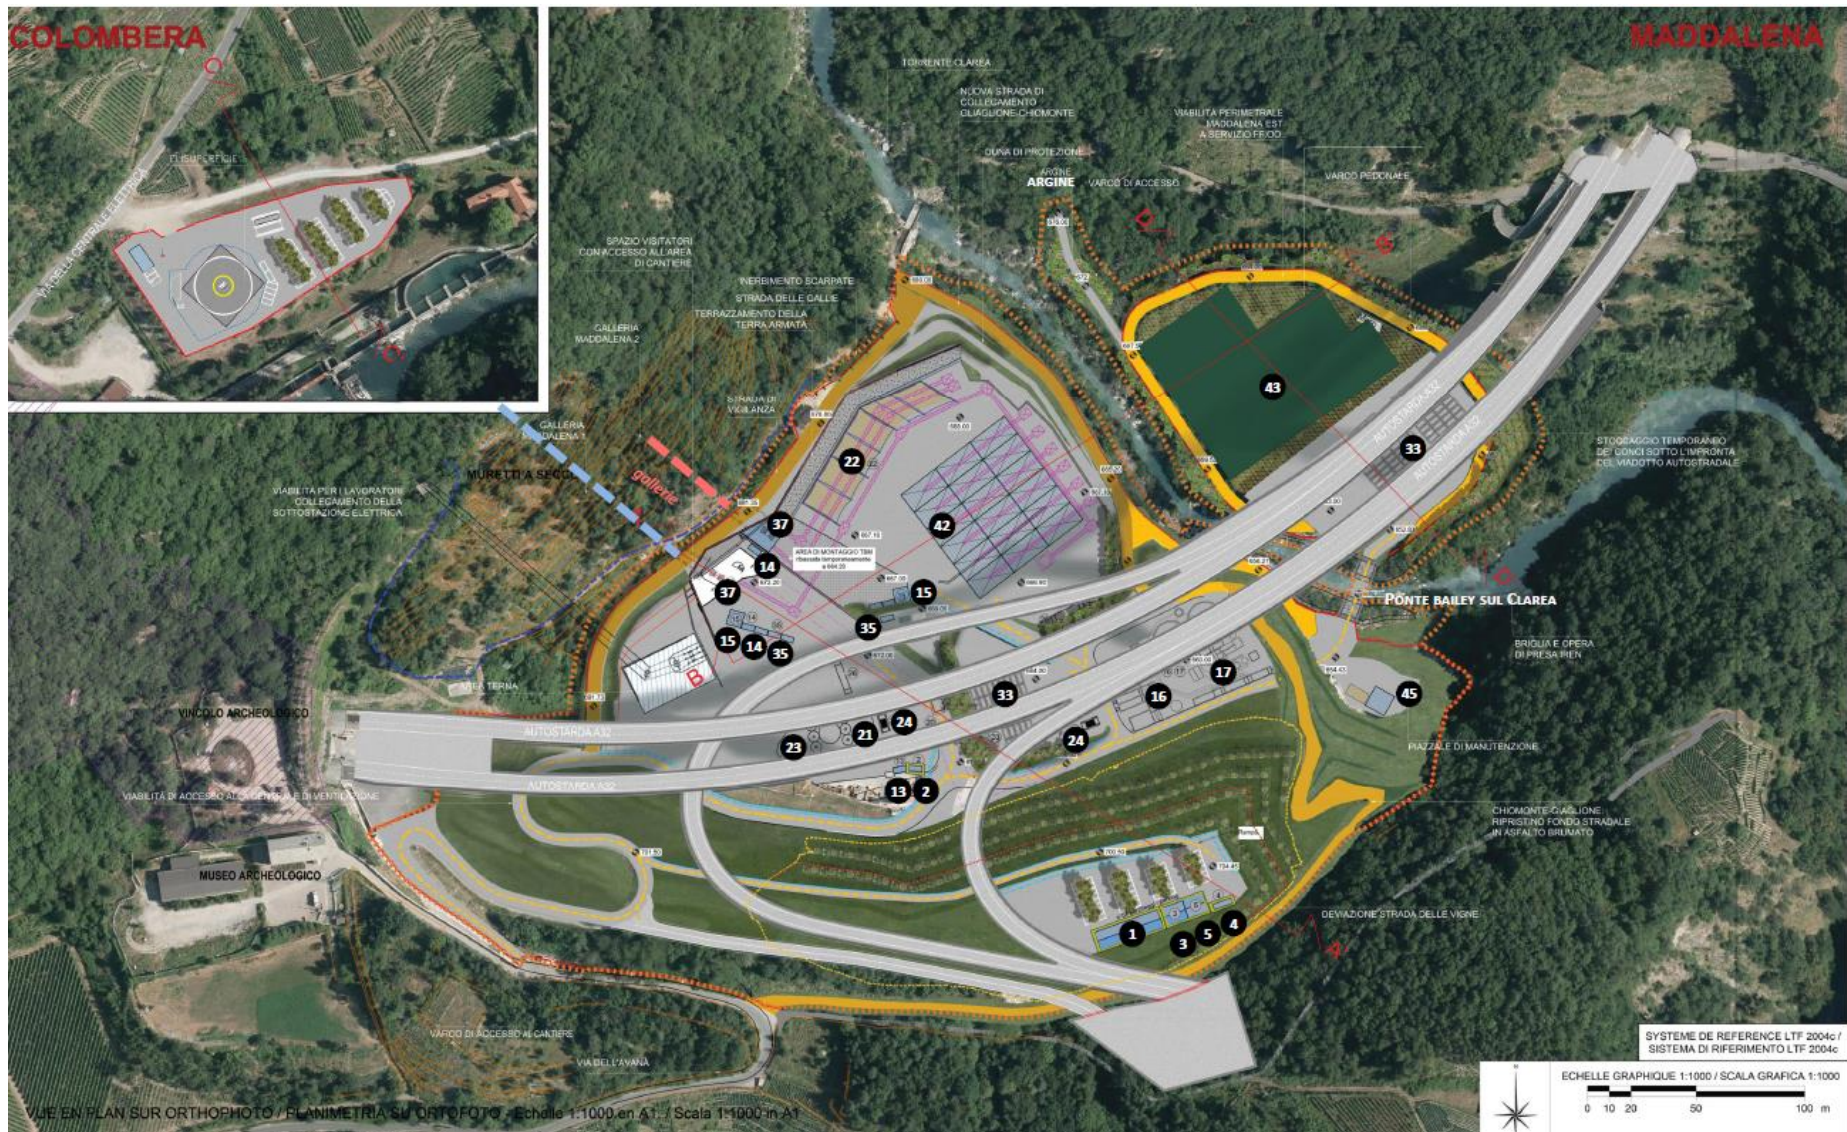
PRV_TS3_C3C_7400: Interventi temporanei e definitivi anticipati in fase di cantiere: Maddalena - Planimetria e sezioni
